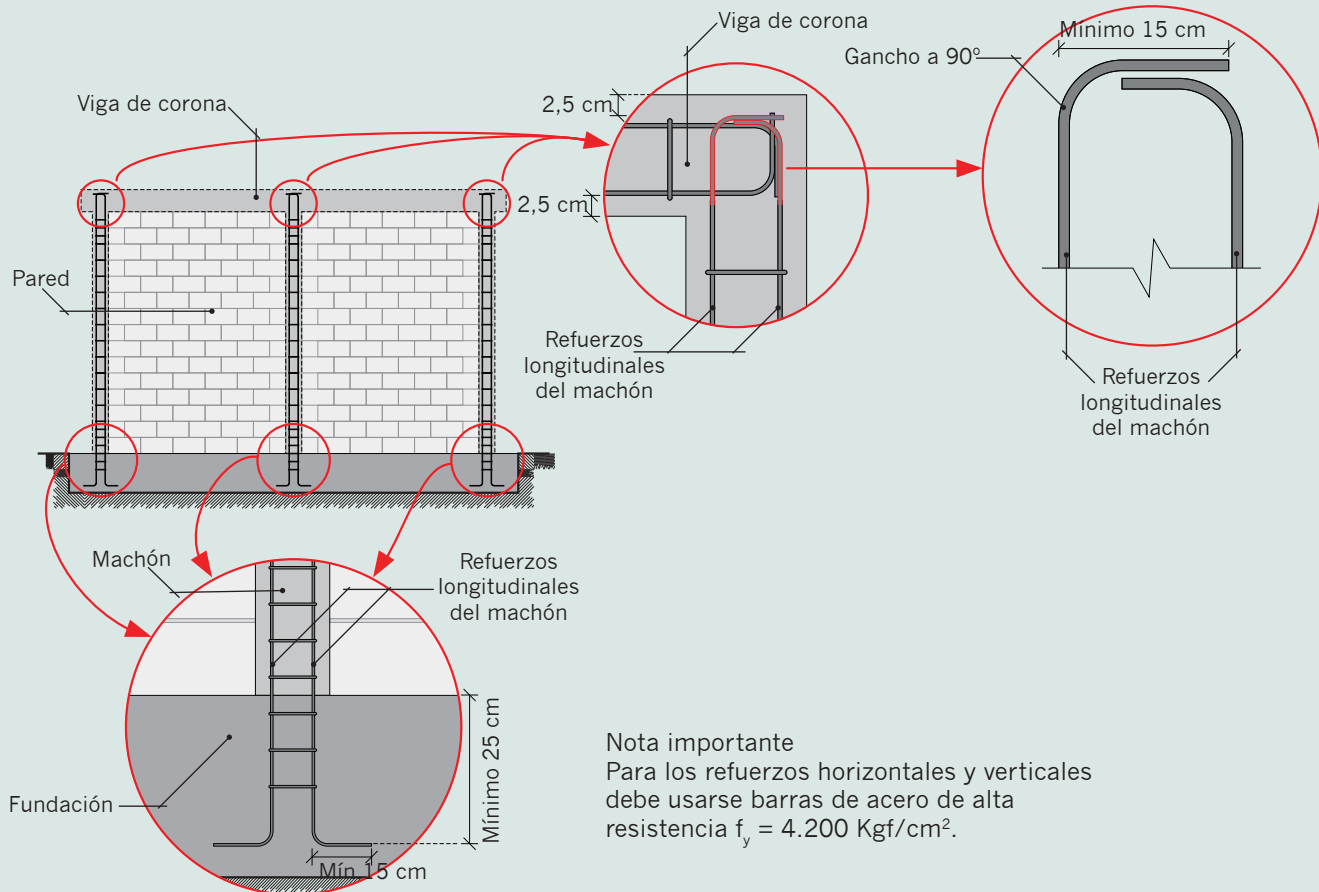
Detallado del acero longitudinal de los machones de concreto reforzado
